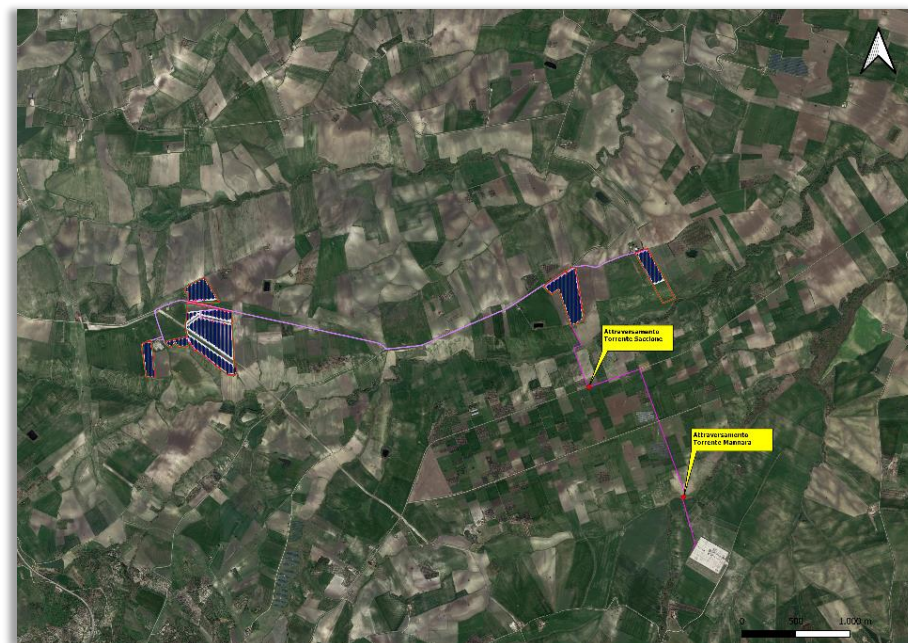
Layout Impianto con indicazione fasce di rispetto condotta SNAM
